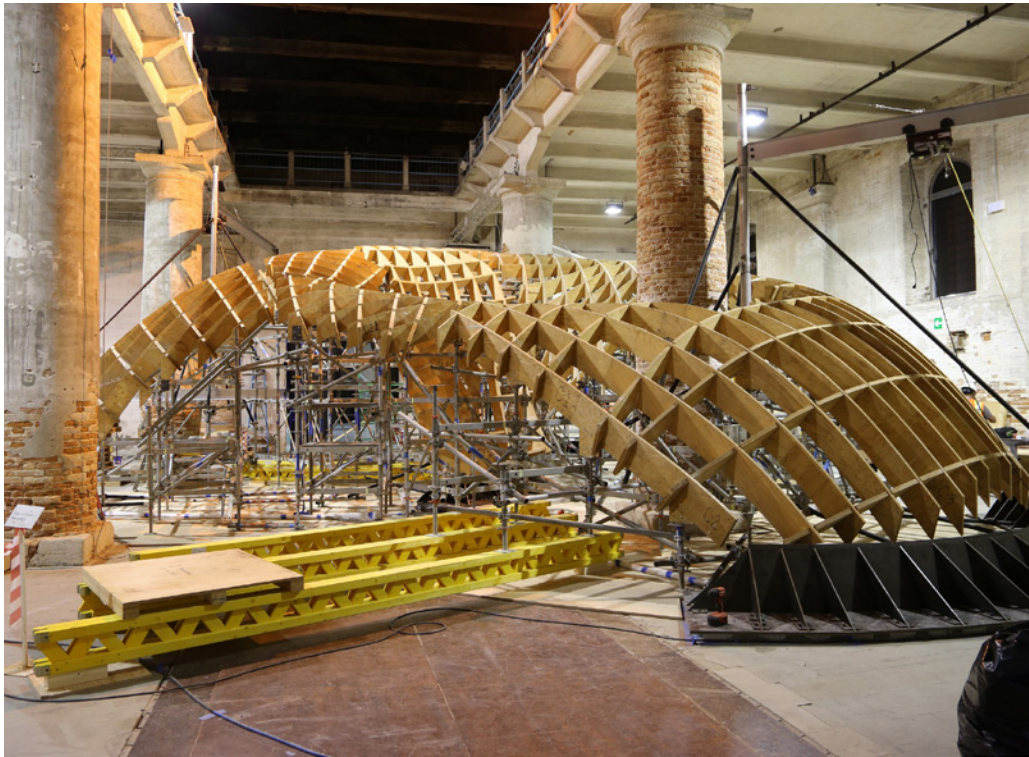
"Armadillo Vault," Installation, Armadillo Vault, consulté le 2 janvier 2019, <http://www.armadillovault.com/armadillo-installation/>.
